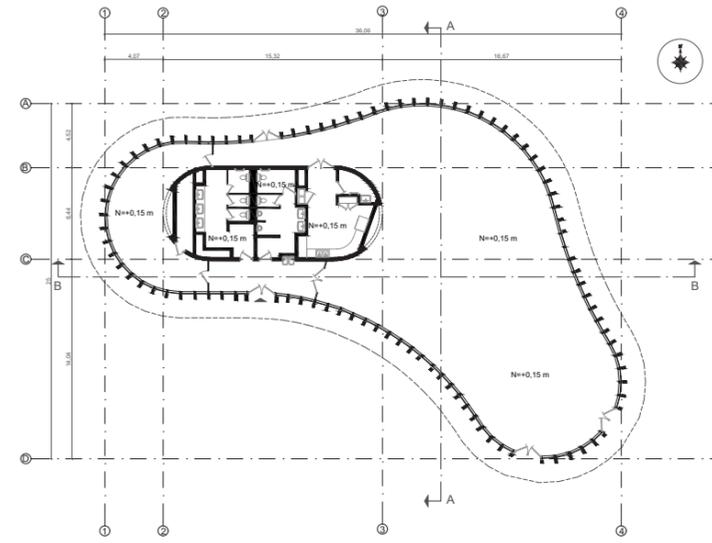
PLANTA ARQUITECTÓNICA
